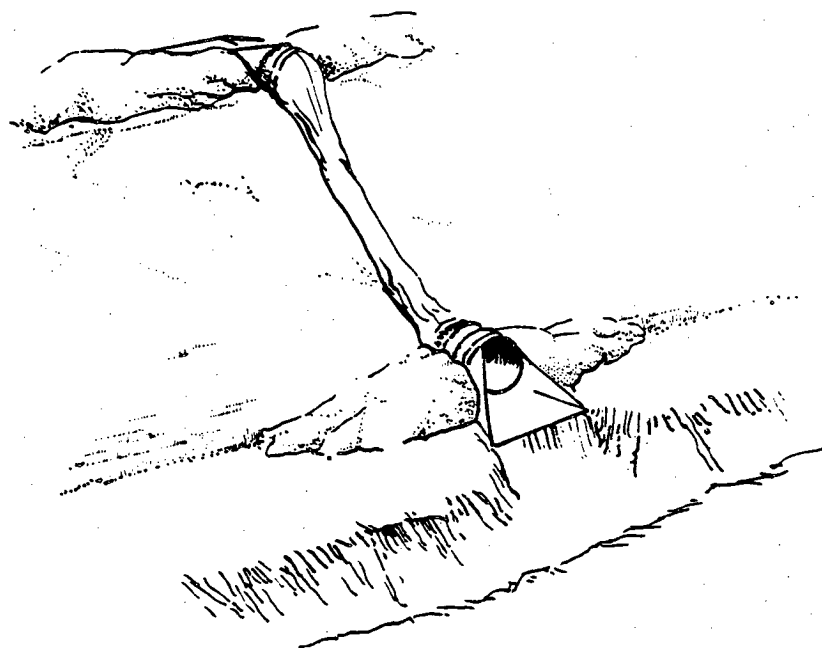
TUYAU FLEXIBLE INSTALLÉ
